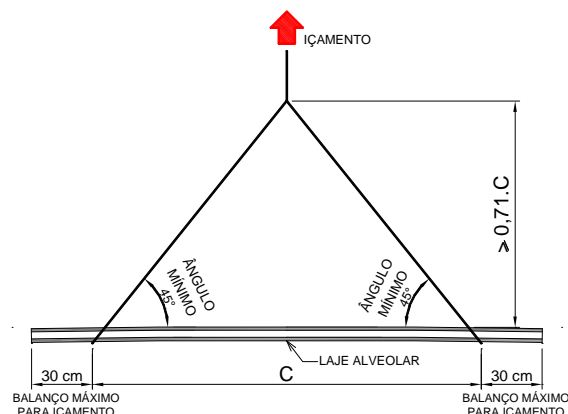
Posicionamento dos cabos para o içamento das lajes alveolares
